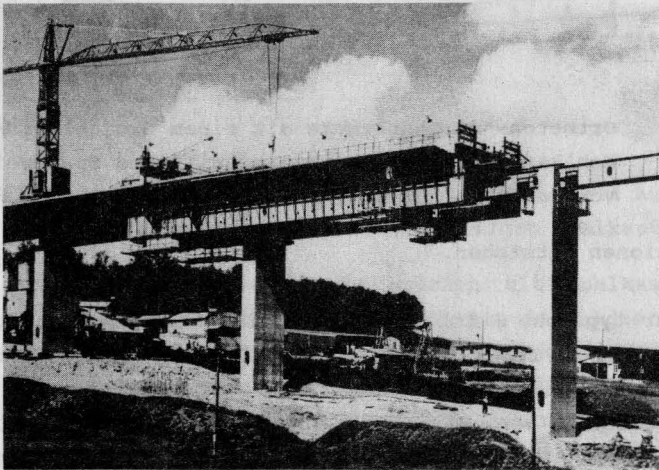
Vorschubrüstung mit kombiniertem mittleren Rüst- und Vorbauträger zur Herstellung langer Tal- und Hangbrücken
